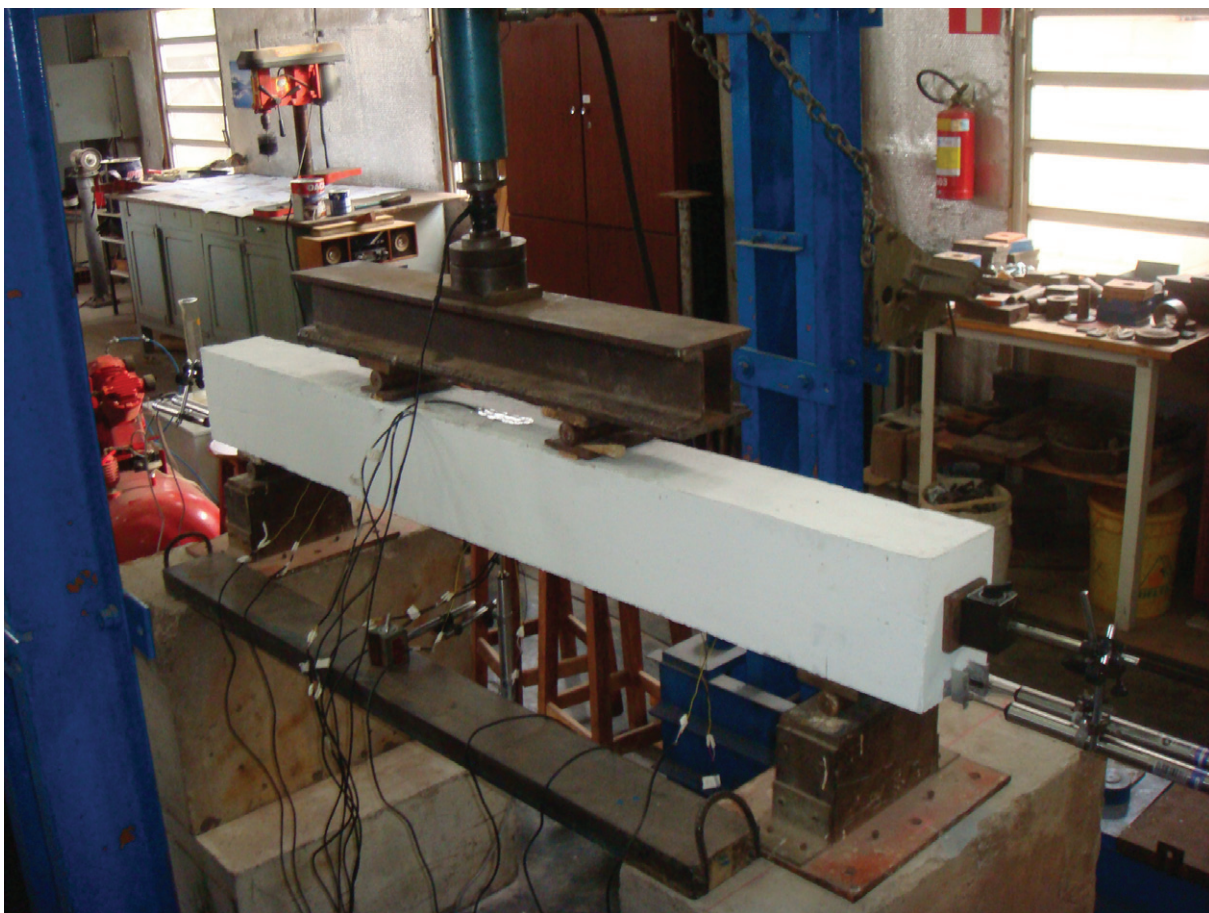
Sistema de aplicação de força durante ensaio da viga reforçada com PRFC.
